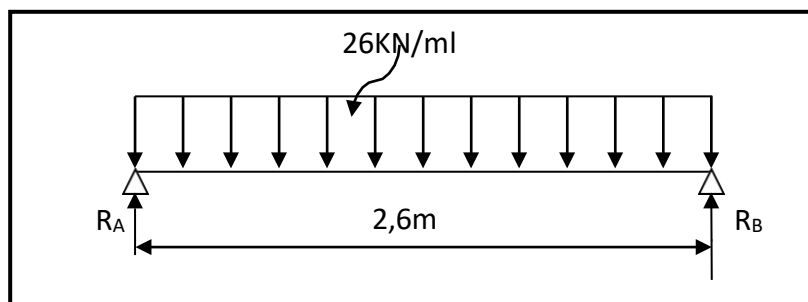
Schéma statique de la poutre palière à l'ELS.
